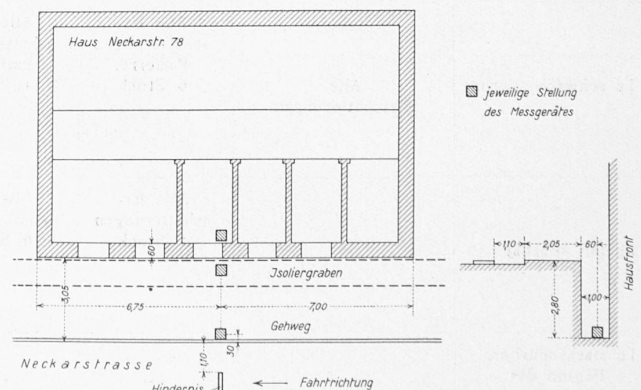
Grundriss und Schnitt von Haus und Isoliergraben, 1 : 250.
